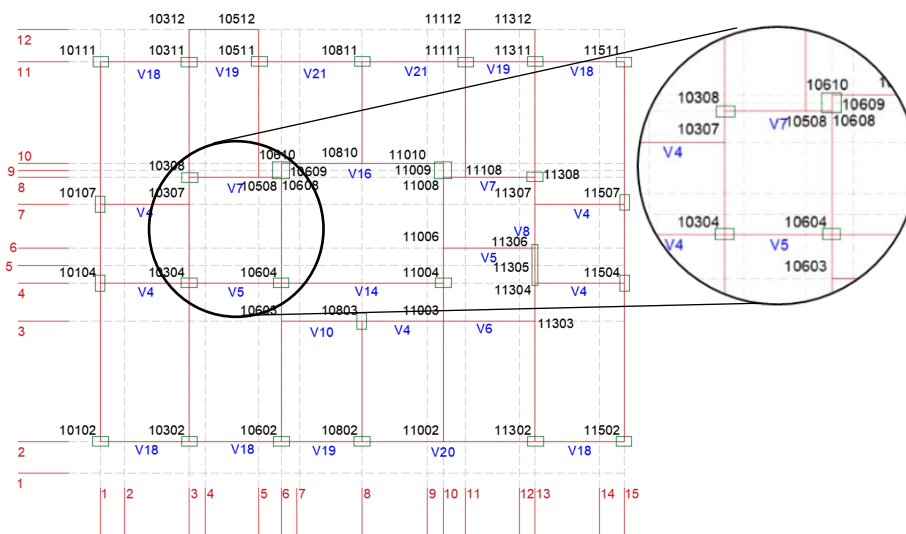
Pormenorização da planta traçada no OpenSees com destaque no alinhamento das vigas
